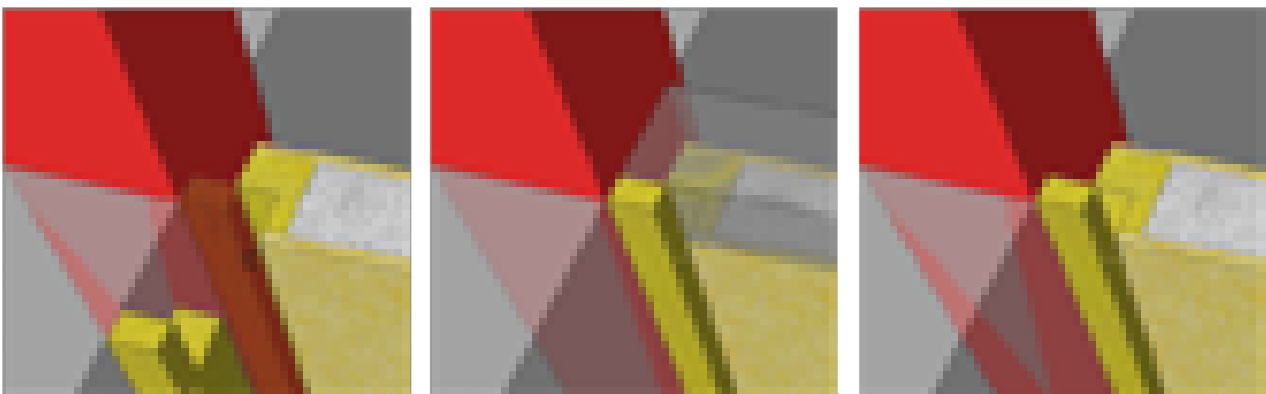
Detalle unión de desmontaje panel-estructura. Fuente: Elaboración propia, 2013.
